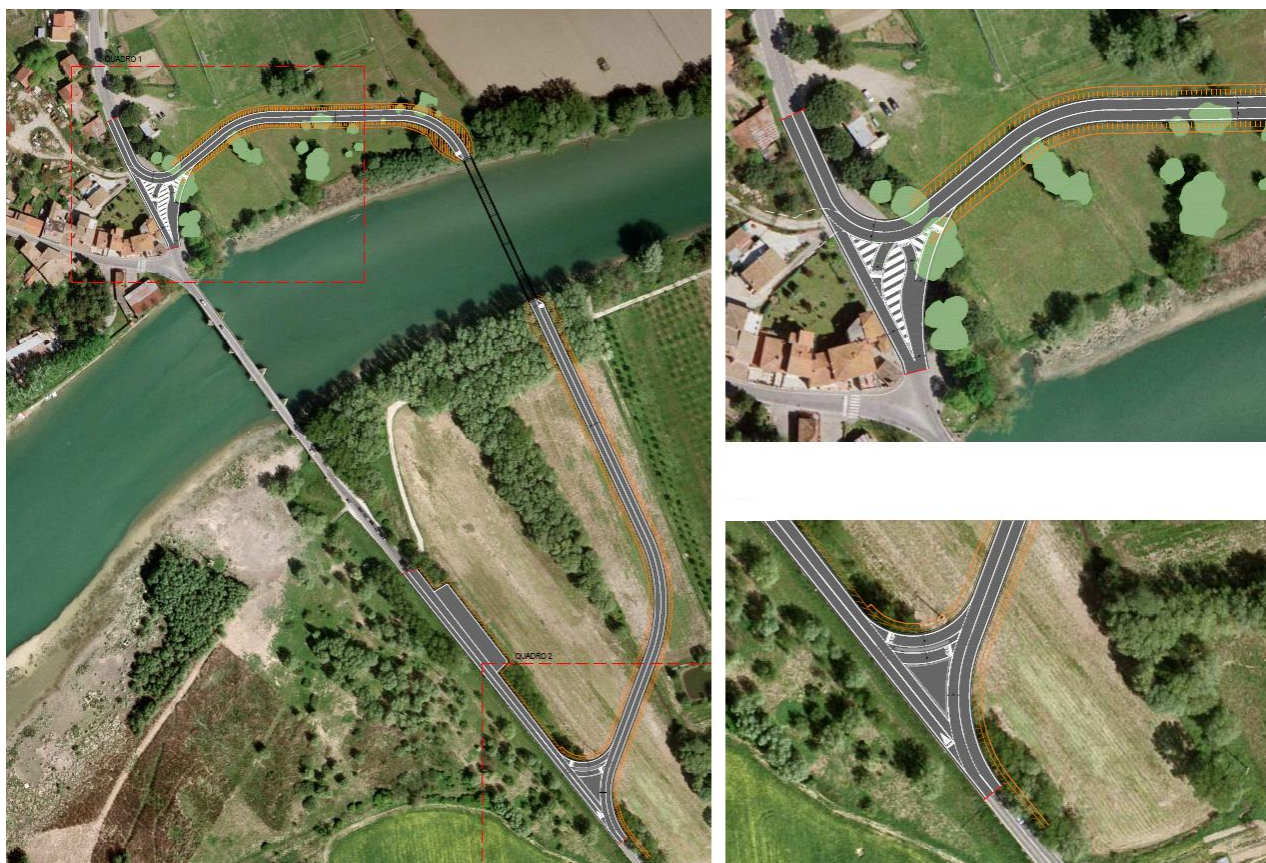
Planimetria di inserimento delle opere previste per la realizzazione della viabilità alternativa e del ponte-guado provvisorio
